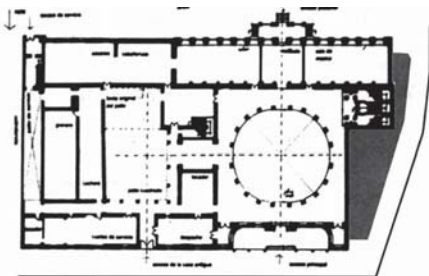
PLANTA ESQUEMÁTICA DEL MUSEO
